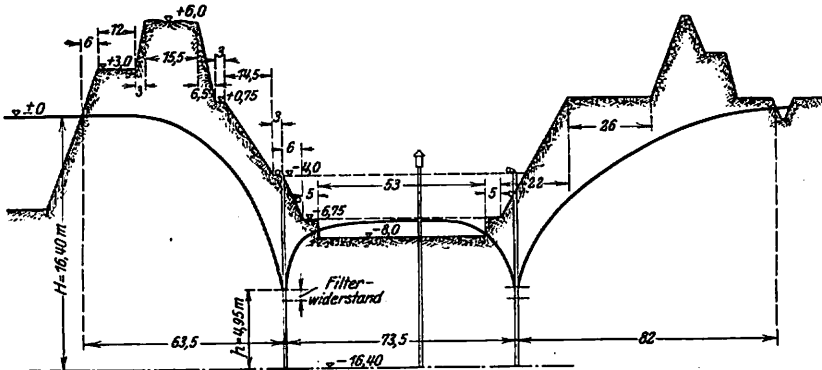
Senkungsanlage für Schleuse Wemeldinge; Schnitt A—B.
